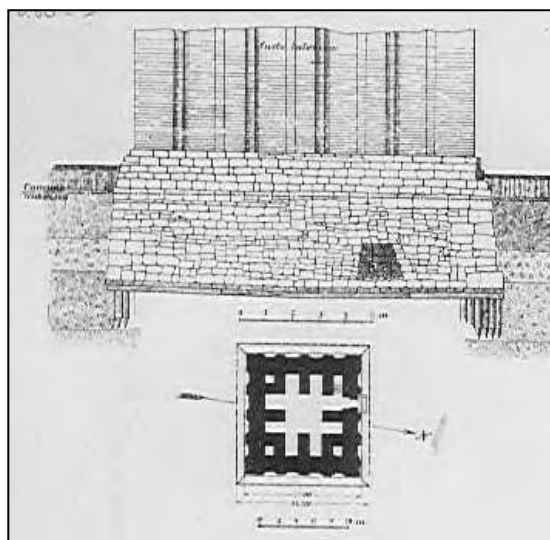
Dado de cimentación y planta a nivel de cimiento del campanario de San Marcos
